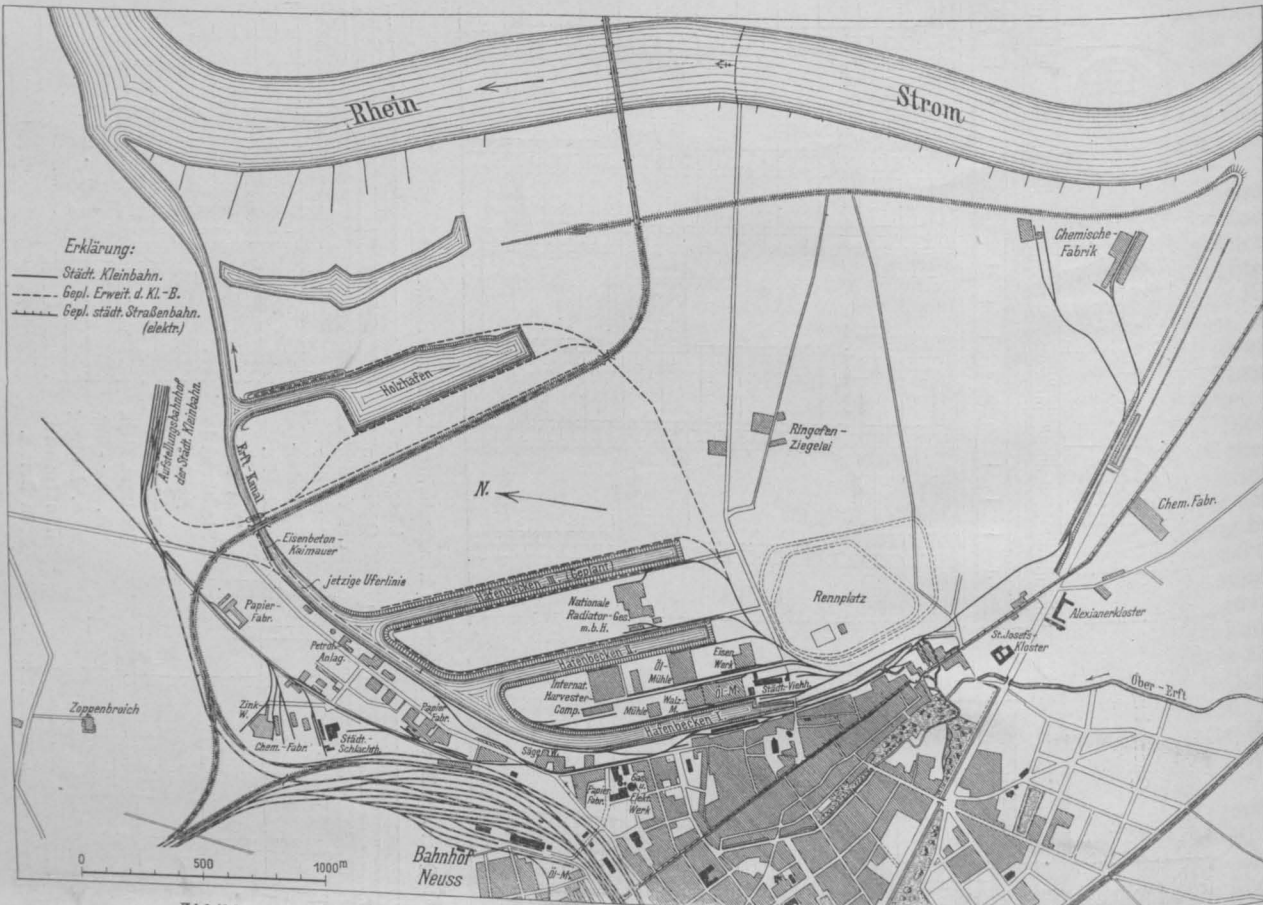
Lageplan der Hafenanlagen der Stadt Neuss (mit den späteren Erweiterungen).
